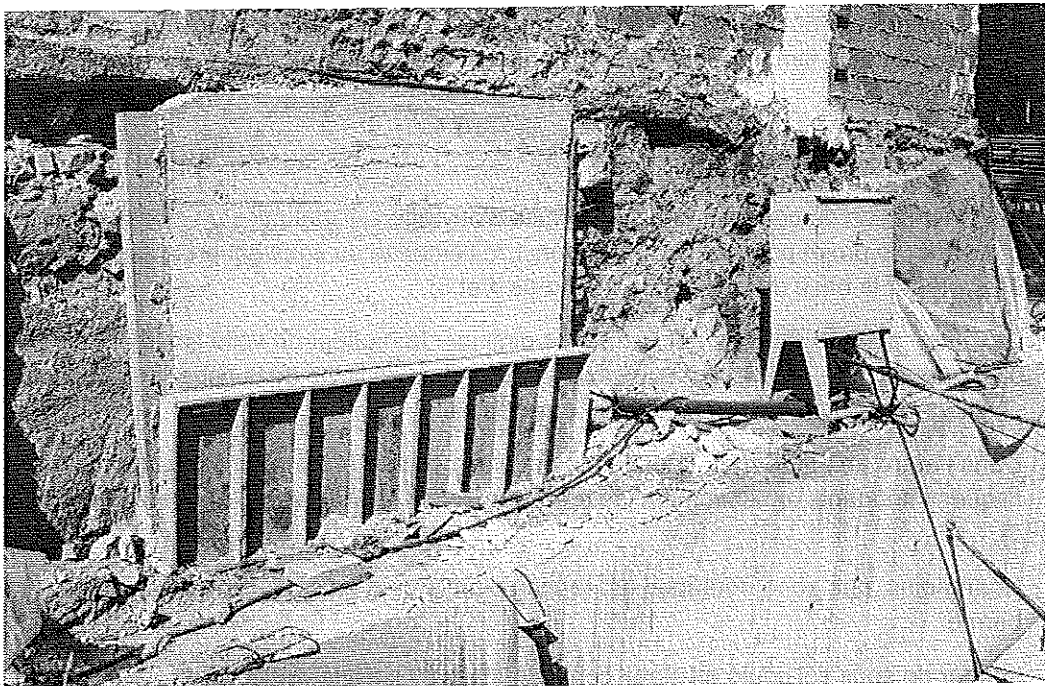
Détail du mur existant à son autre extrémité. Reprise partielle en sous-œuvre. Présence d'une risberme. Voile BA en sous-sol coulé en place. Terrain sous-jacent taillé à la verticale, sans protection. © J. Putatti
